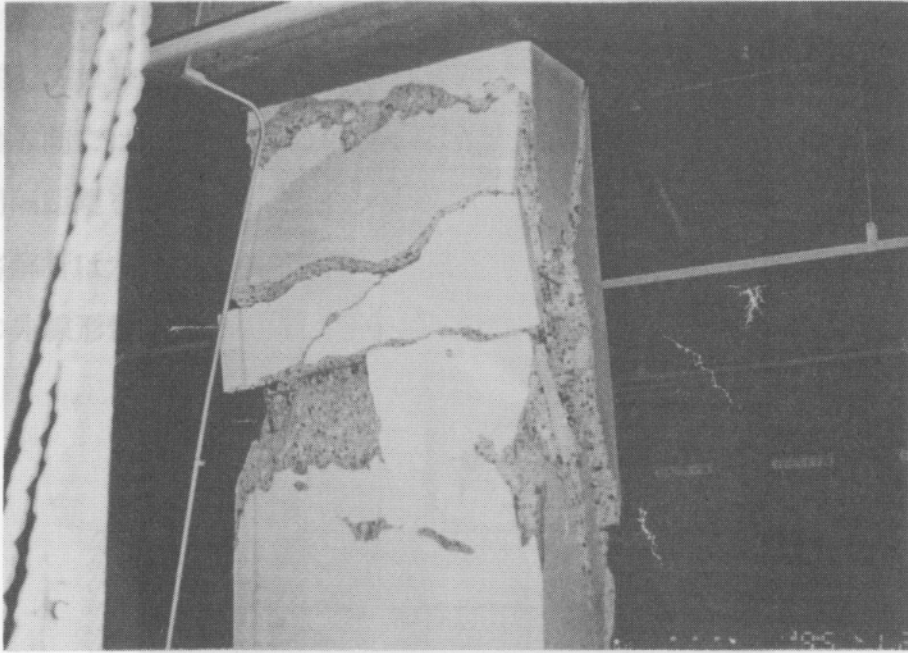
上沢駅B1階 中柱のせん断破壊 (写真提供：神戸市交通局)
